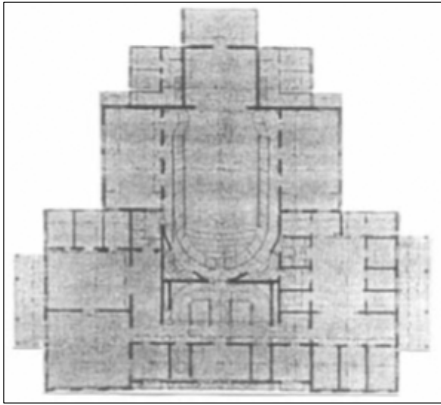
Tayyare Sineması, restorasyon sonrası birinci kat planı [273]
